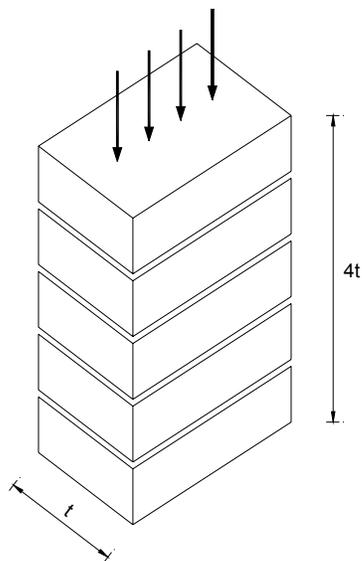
PILA DE MAMPOSTERÍA PARA ENSAYE DE COMPRESIÓN
